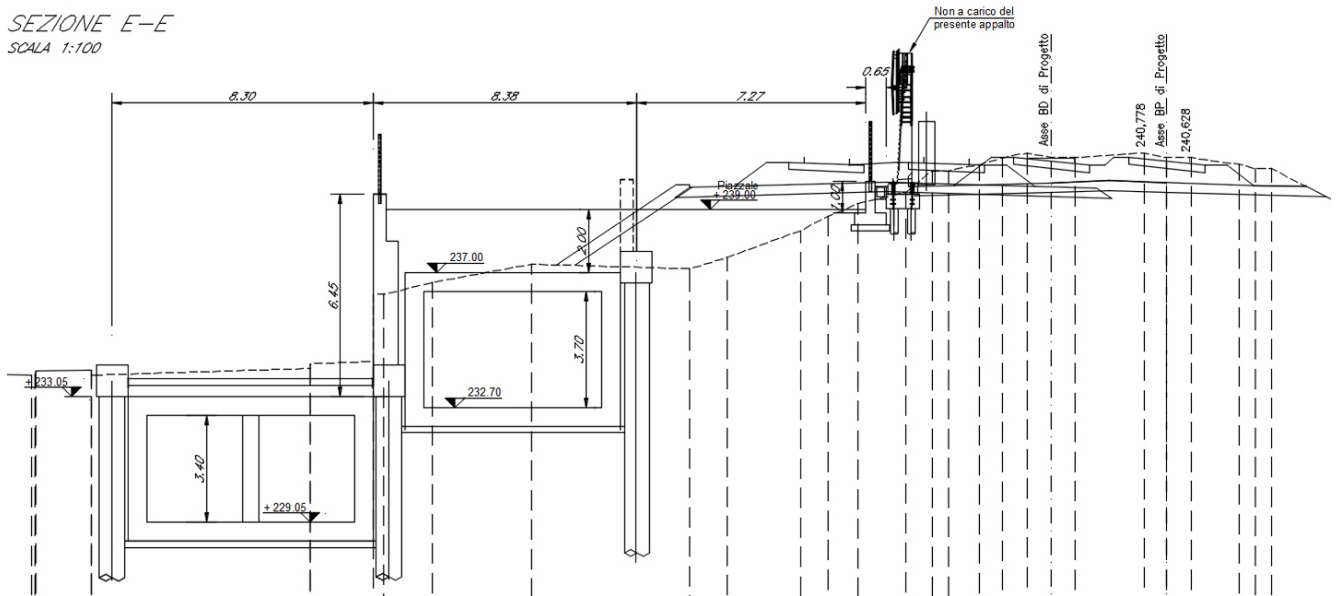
Sezione trasversale Piazzale e vasche di laminazione
